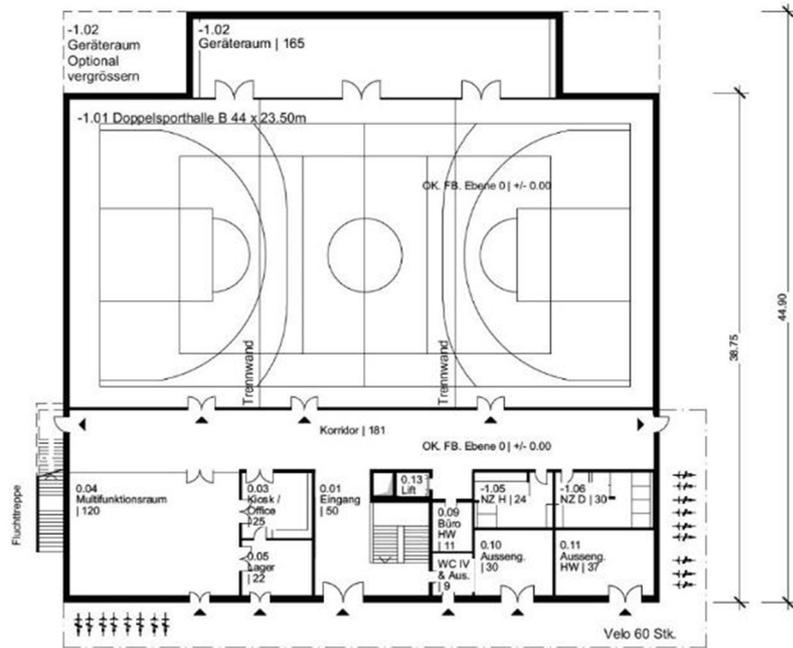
„aufgesetzte“ Doppelsporthalle B | Disposition 2 - Grundriss Erdgeschoss
